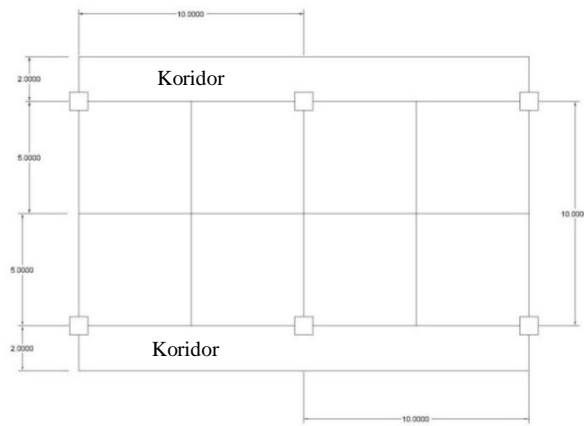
Alternatif 1b. Modul 10 m x 10 m
